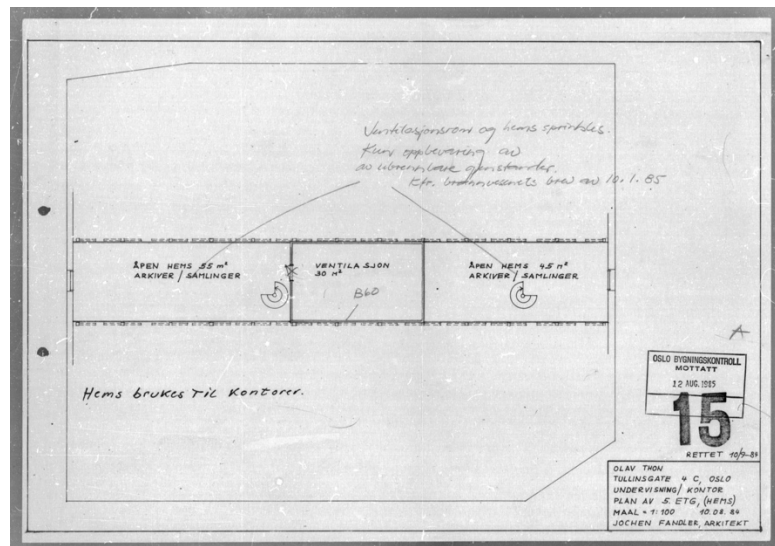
Plan 3 etg. -1984 . Kilde: Plan- og bygningsetaten.
